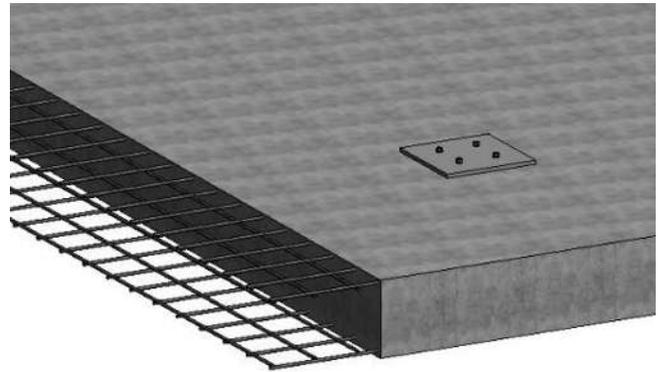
Esquema losa de cimentación. Fuente: Elaboración propia
